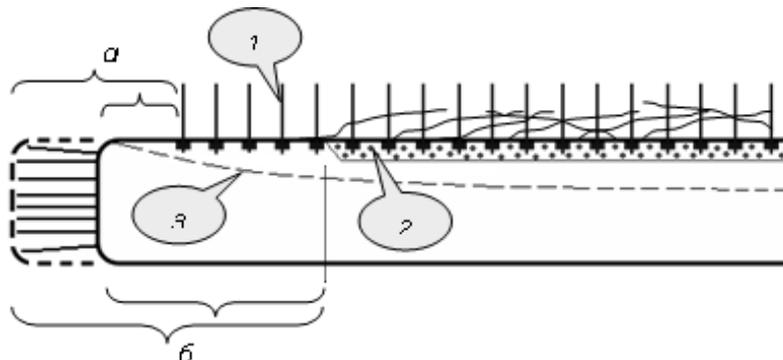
Отставание от забоя выработки до и после ухода за цикл: а) анкерной крепи 1; б) торкретбетонной крепи 2;3 - смещения кровли
